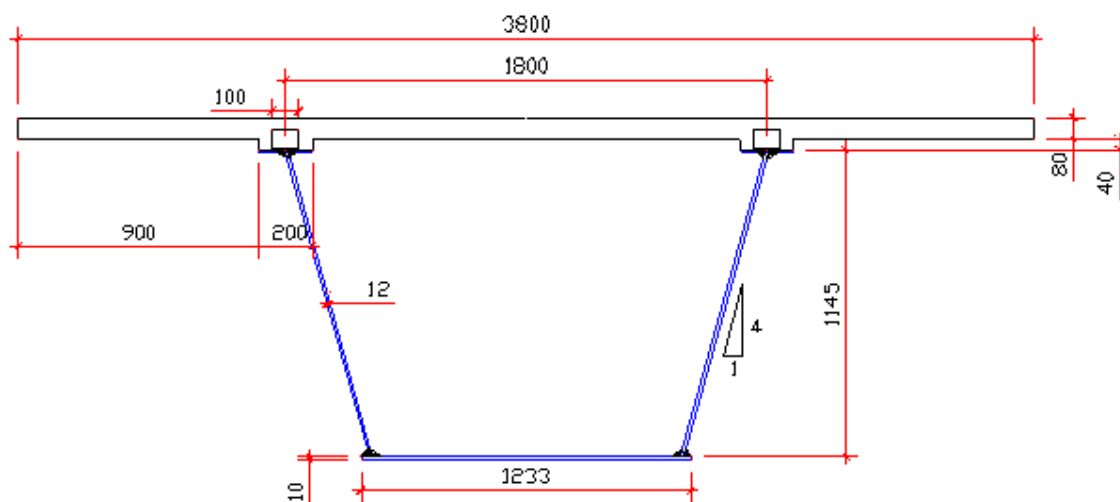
1ª Opção de viga, desenho da seção transversal trapezoidal (dimensões em mm)
